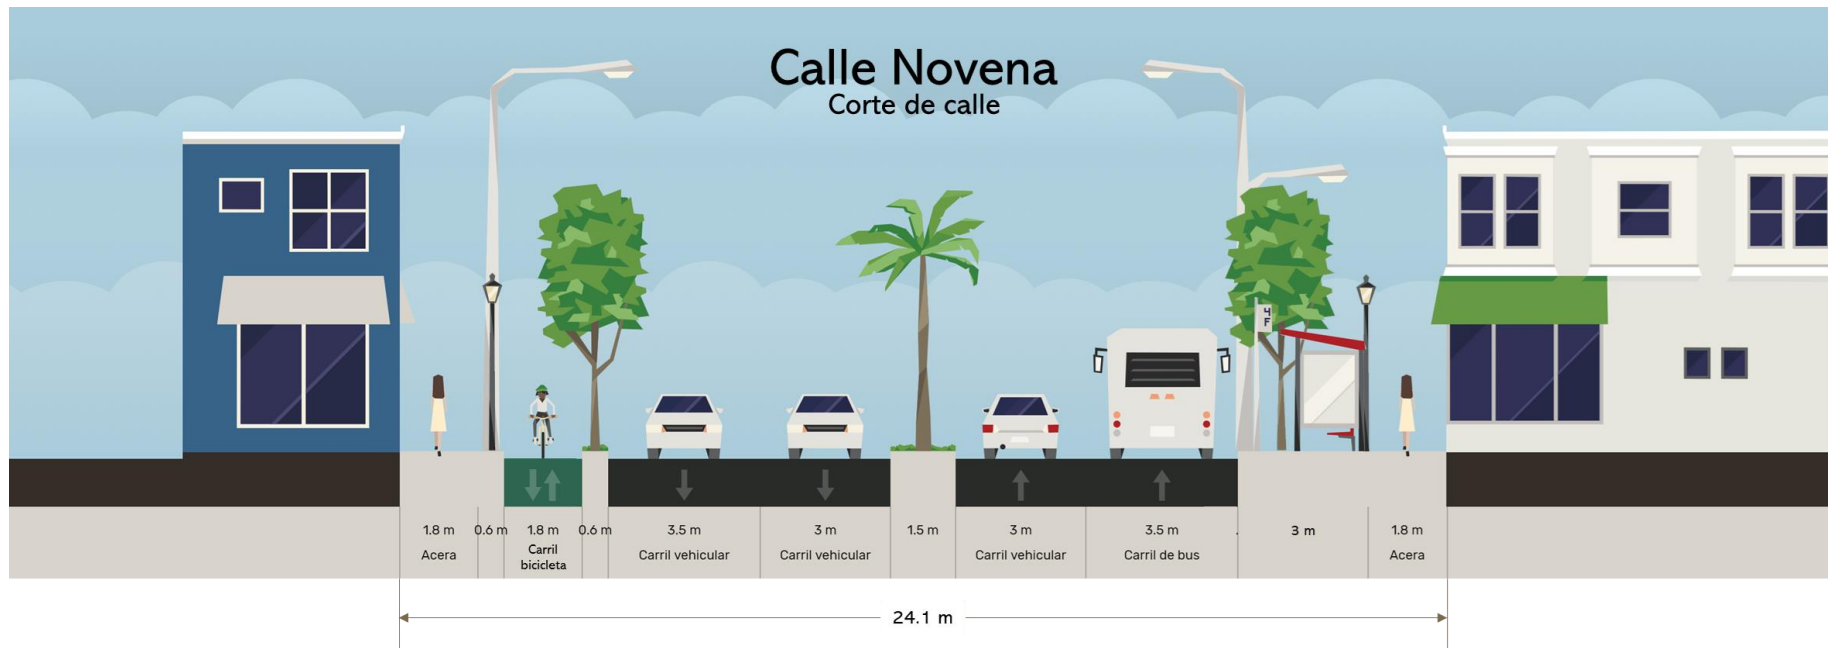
Detalle distribución de propuesta para calle Novena (corte).
